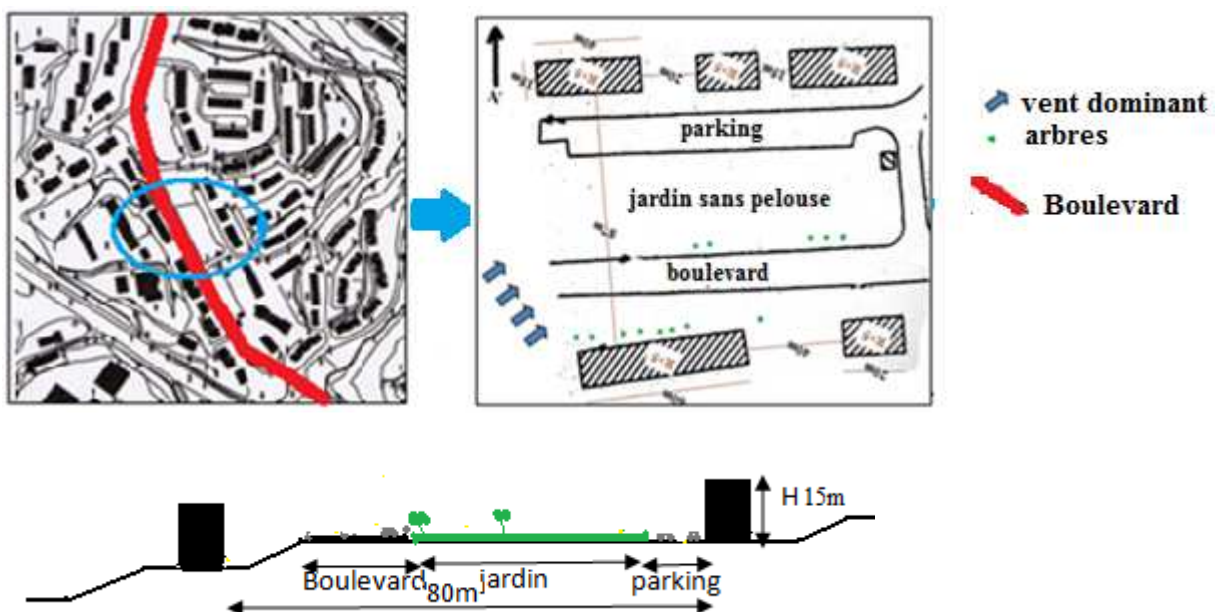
Plan et coupe sur le boulevard Source : auteur
